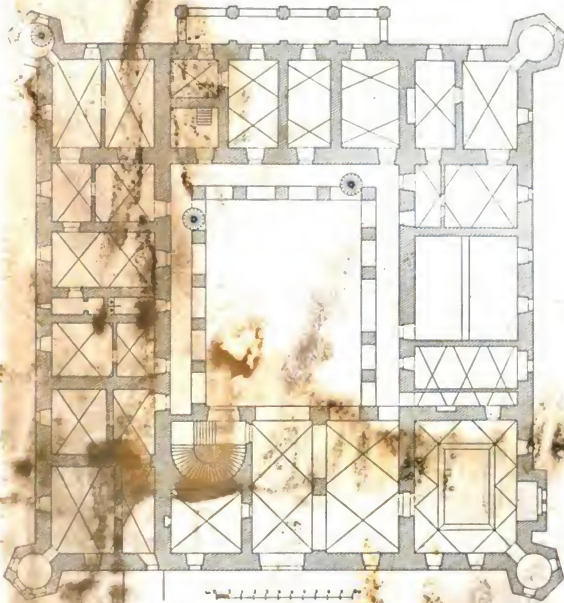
Unter-Beřkowitz. Grundriss des Schlosses.
